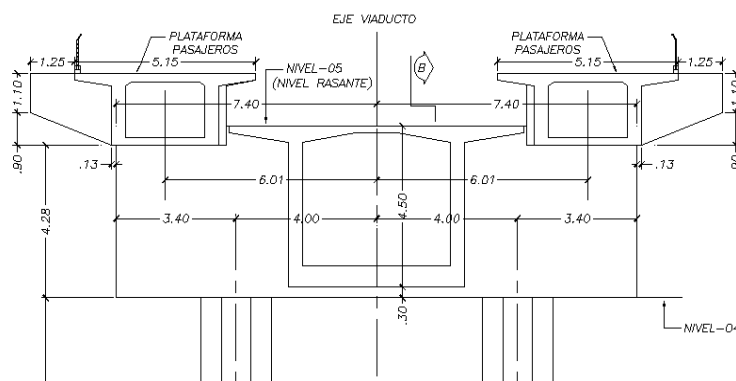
Sección transversal en Viga Cabezal en Pilares S50 y 51
